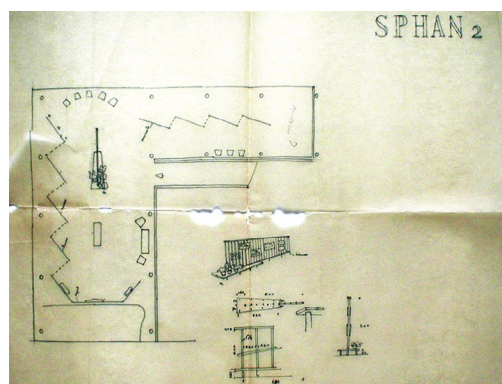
Croqui de instalação da exposição *Arte Tradicional Mineira*. Primeiro pavimento.¹³⁶
